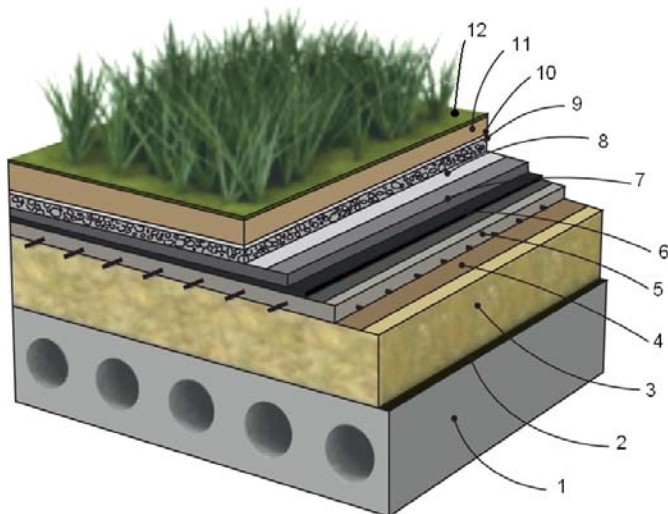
Схема конструкции «зеленой» крыши: 1 — несущая конструкция; 2 — пароизоляция; 3 — теплоизоляция; 4 — водоизоляционный слой; 5 — выравнивающая стяжка; 6 — гидроизоляция; 7 — мембрана; 8 — геотекстиль; 9 — гравий; 10 — геотекстиль; 11 — растительный грунт; 12 — озеленение
